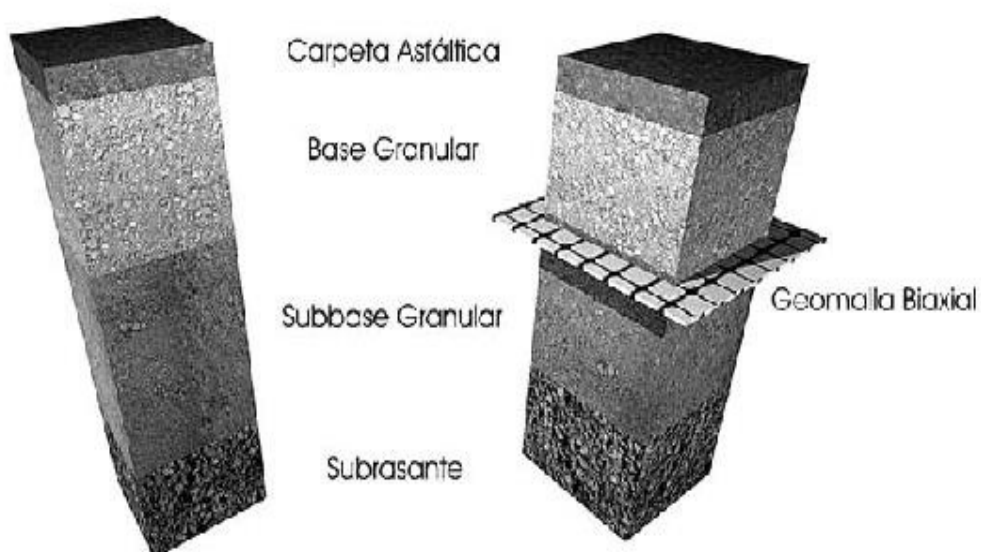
Sección típica de estructuras de pavimento asfáltico
